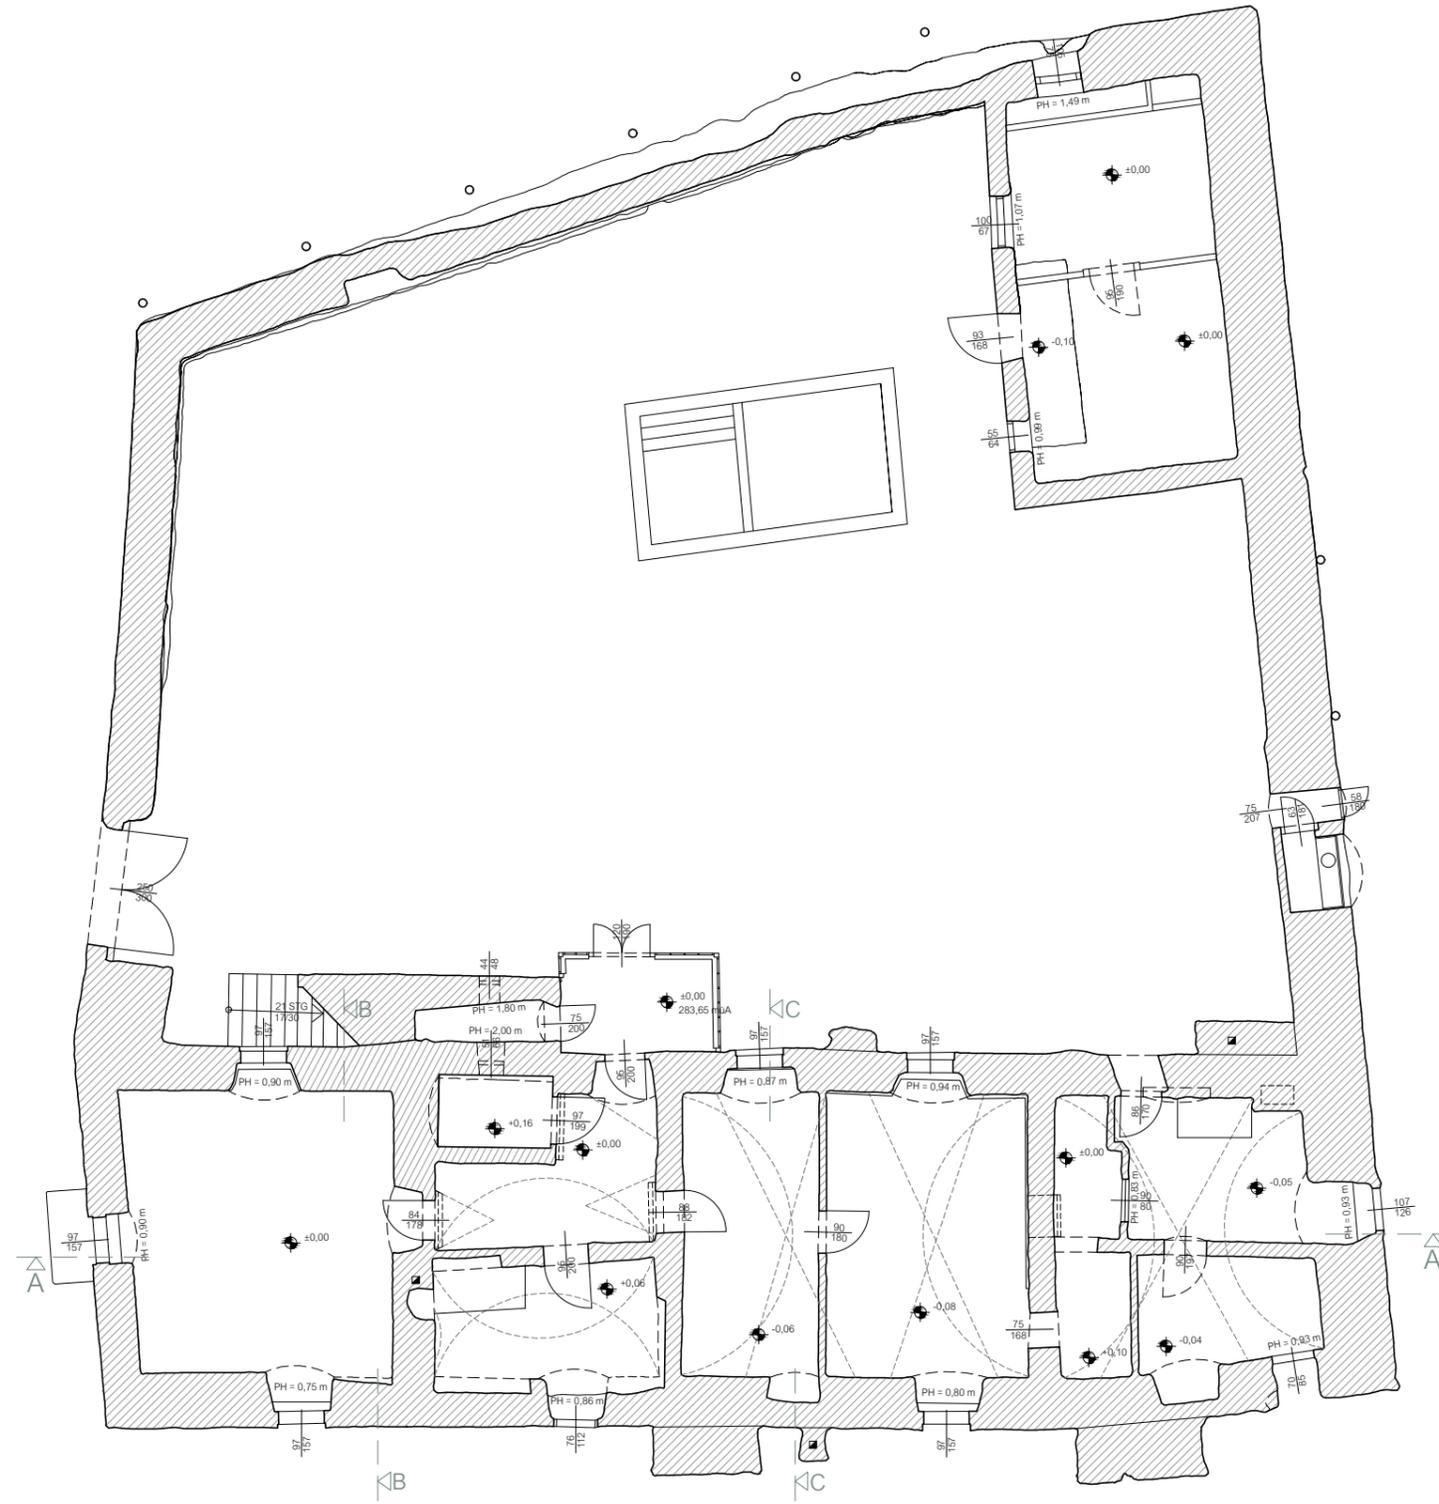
Bestandsplan, Erdgeschoß, M 1:150
